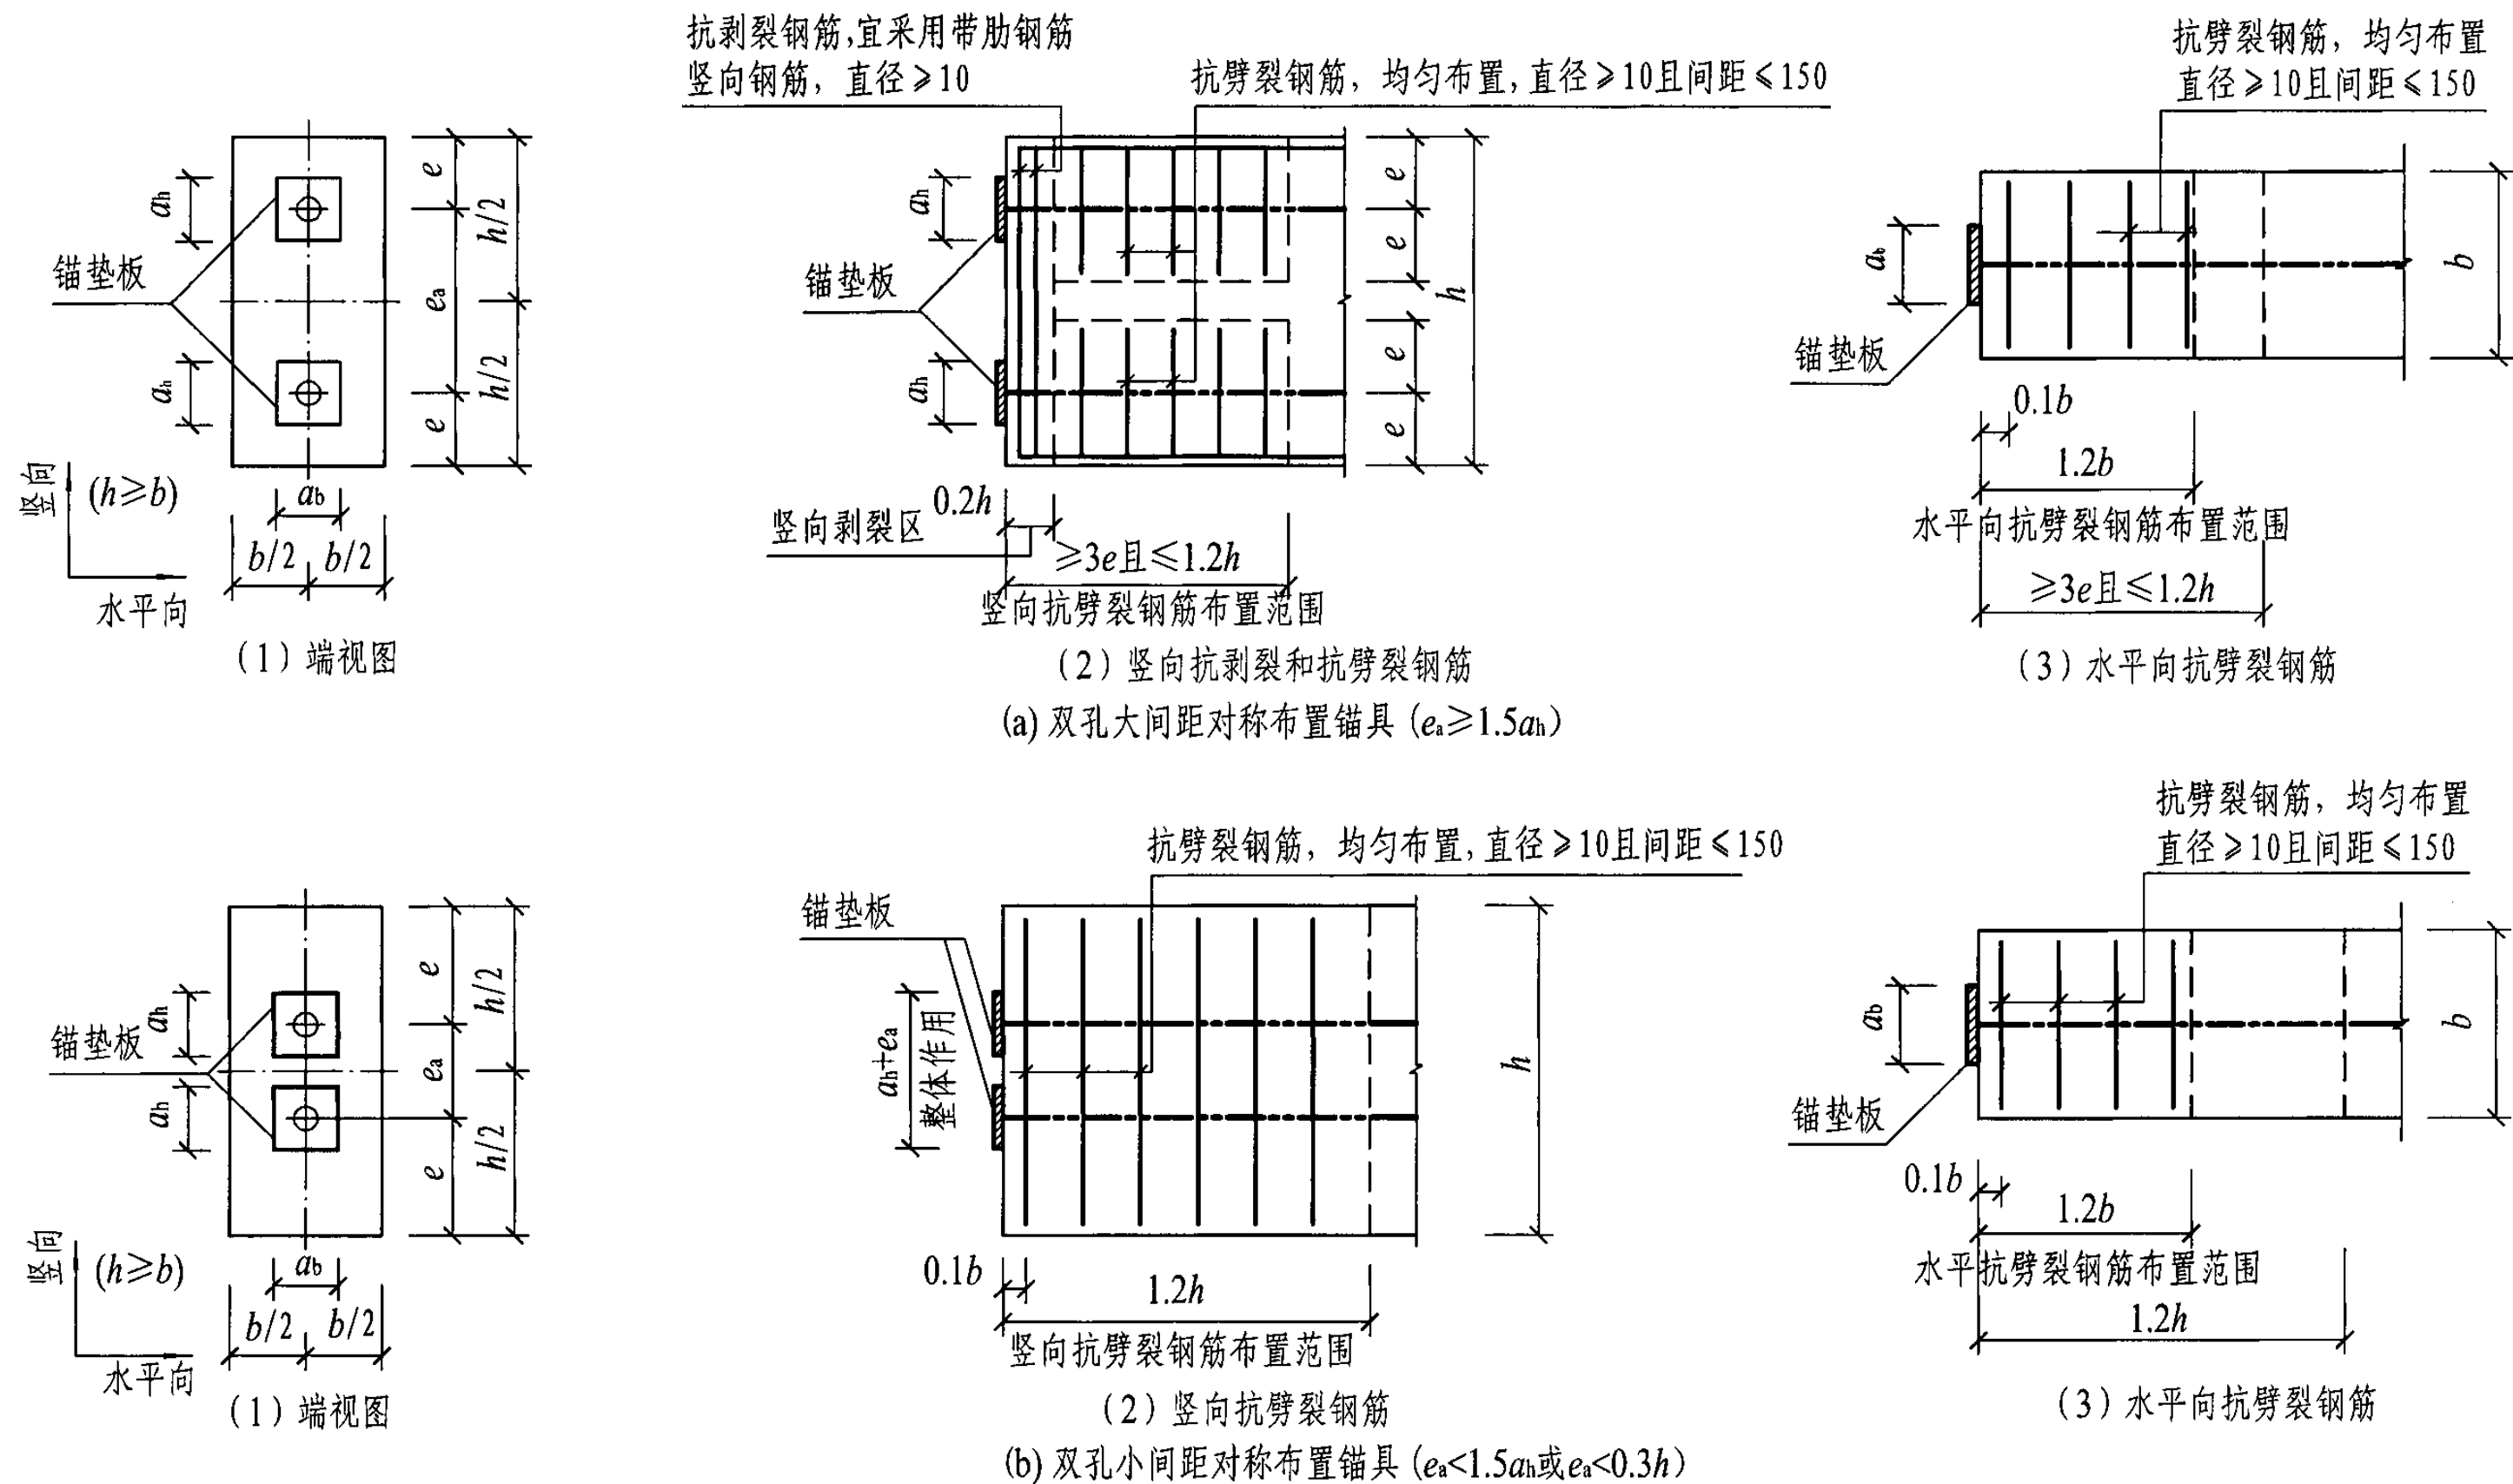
双孔锚具锚固区抗劈裂和抗剥裂钢筋构造
